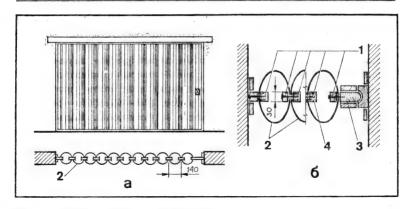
Легкая мягкая перегородка: а — общий вид перегородки; б — узлы и детали перегородки; 1 — шурулы; 2 — искусственная кожа; 3 — ведущая планка; 4 — рейки 30×(10—15) мм
